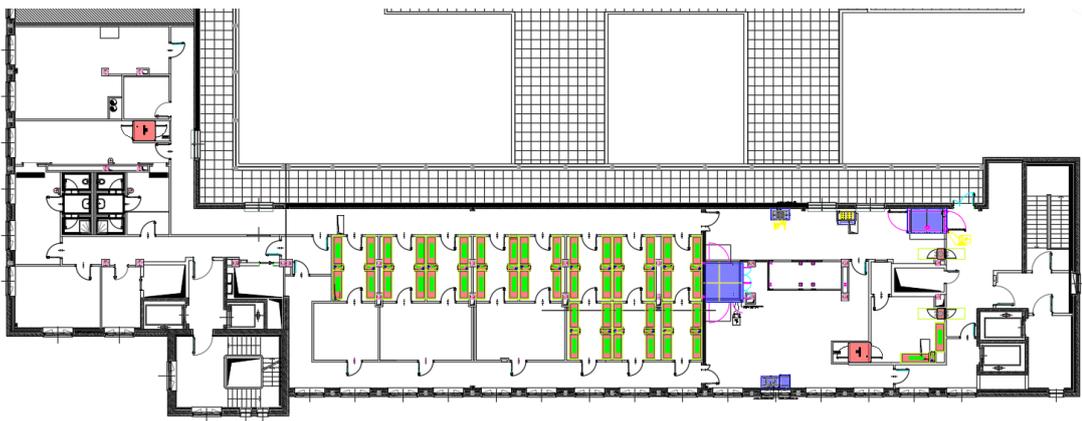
Stralcio della planimetria del Centro tumori Milano con macchinari⁶
